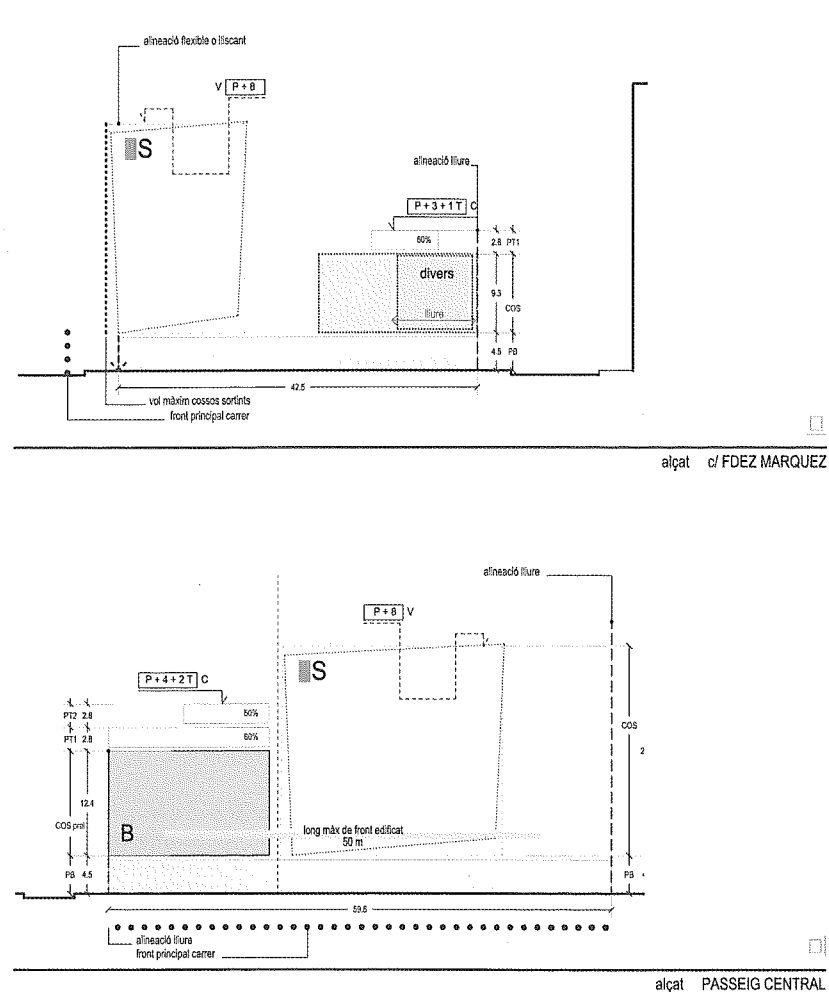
PERM, 2002. Condiciones Detalladas de la Edificación: regulación de la manzana R-5b. Situación y condiciones en planta y en alzado.
